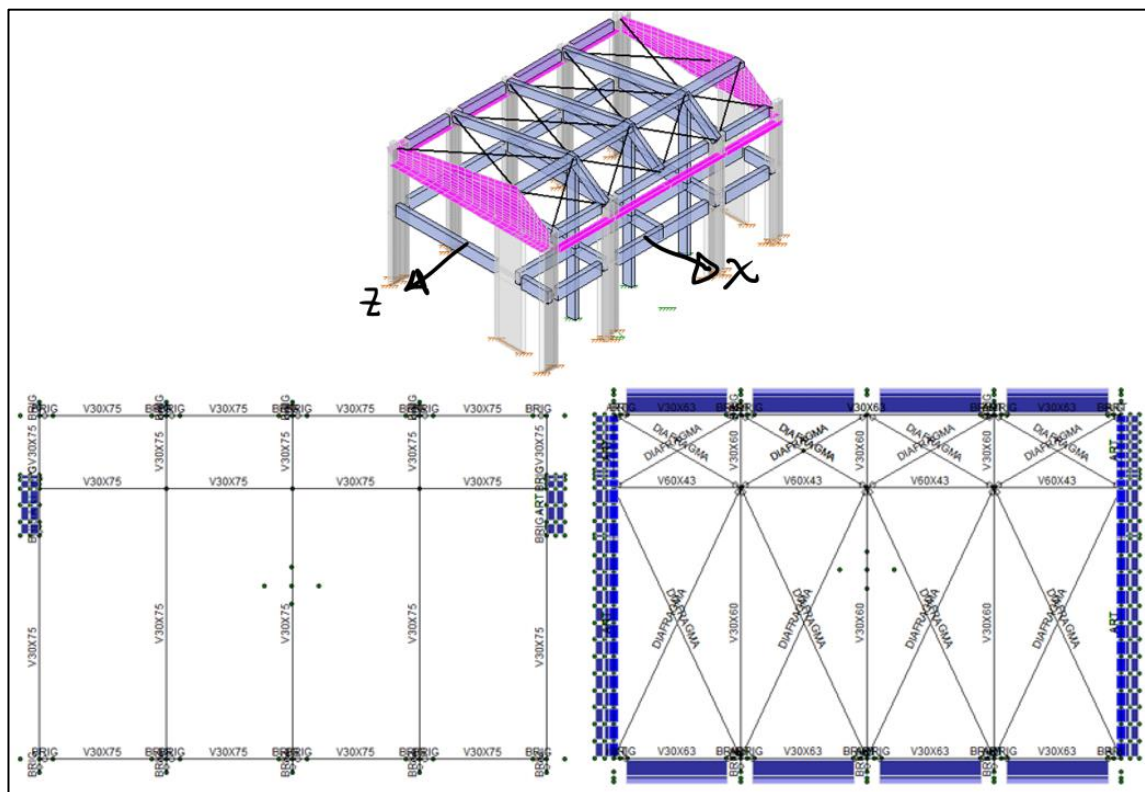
vista de planta típica de la edificación. Se aprecia diafragma del primer y segundo techo del Módulo 2.
